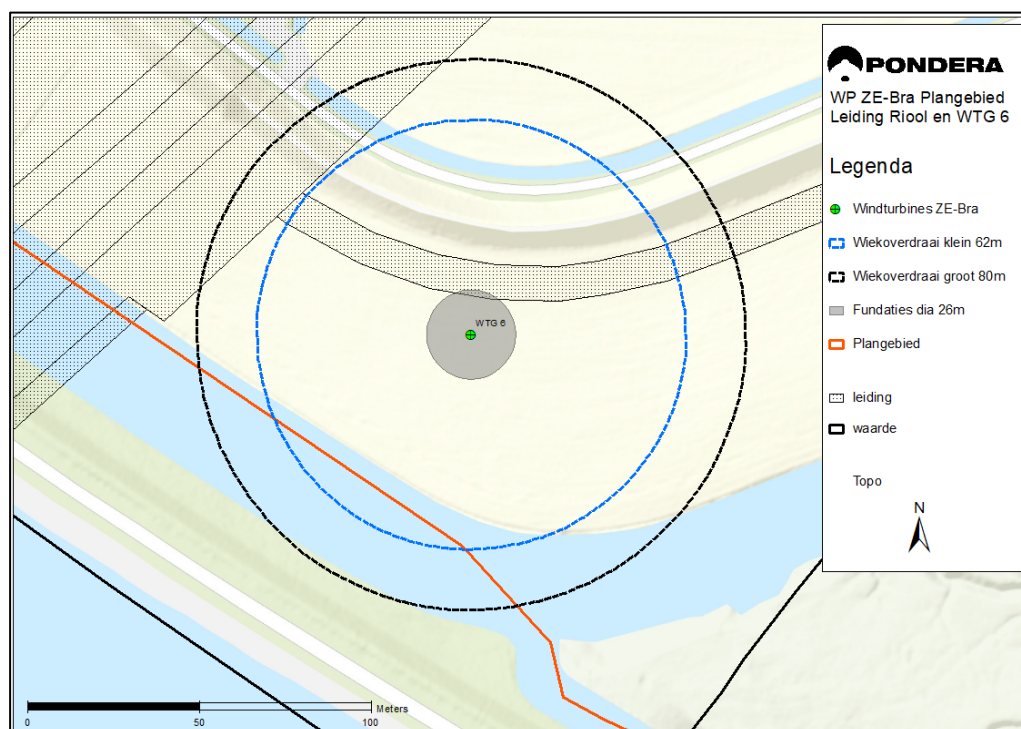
Overdraai turbines over bestemde strook voor rioolleiding
